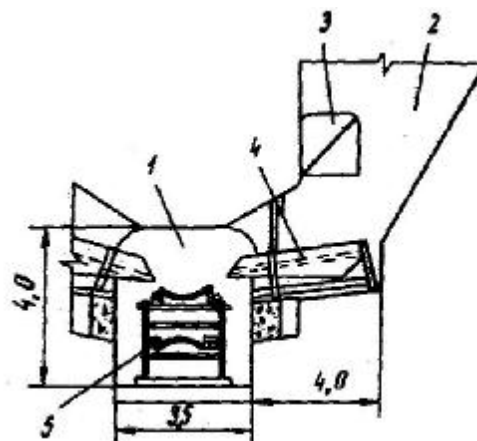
Схема выпуска-доставки руды: 1—конвейерный штрех; 2—выпускная дучка; 3—контрольный ходок; 4—ПВРА-4,5/1,4; 5—КЛТ-160
